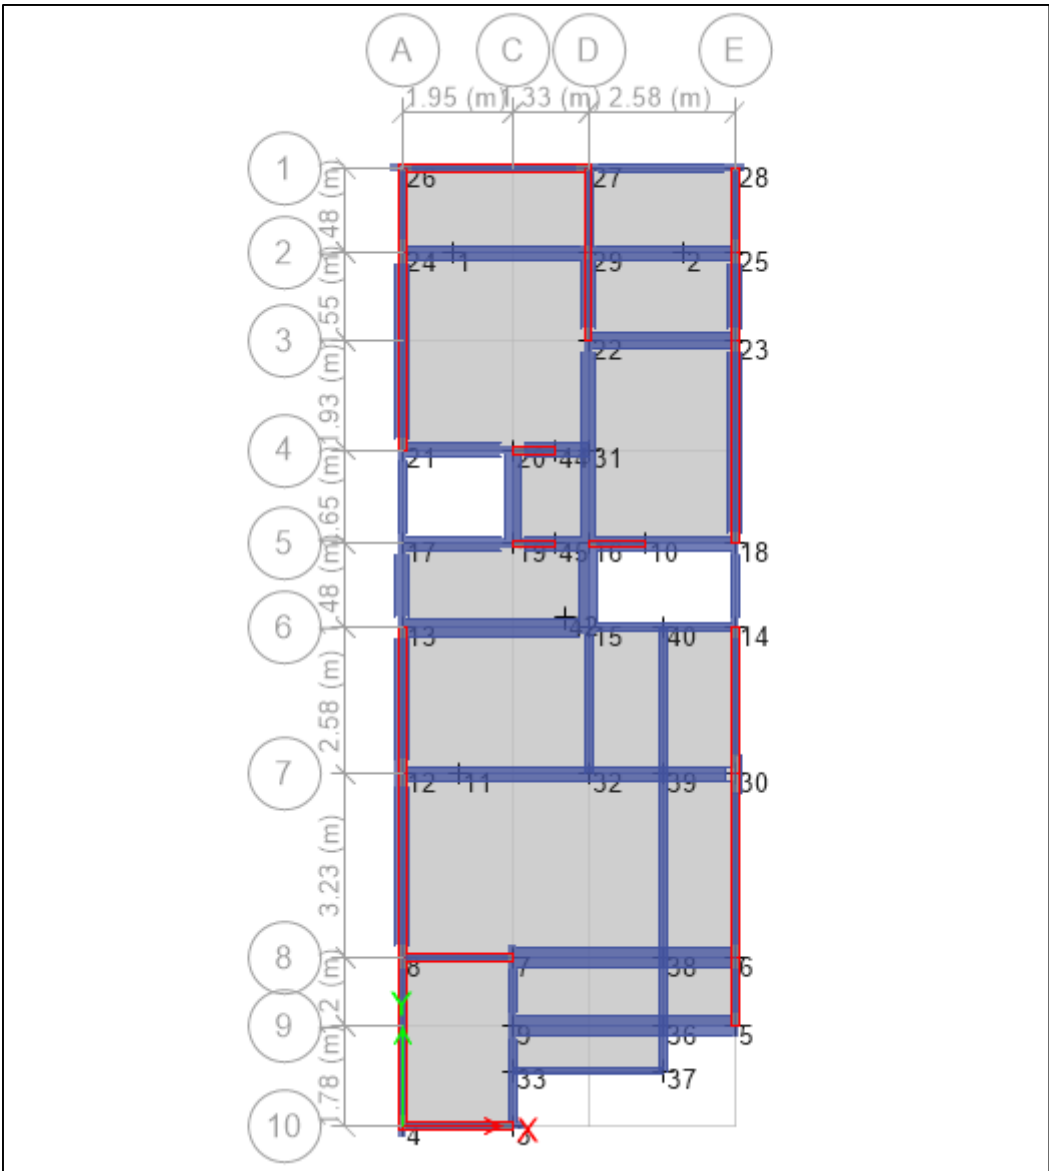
Detalle del nivel uno para el modelamiento estructural.
